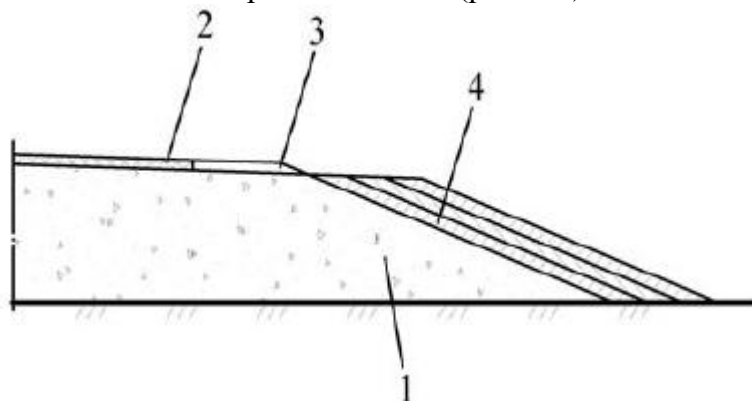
Порядок послойной отсыпки грунта наклонными слоями:
